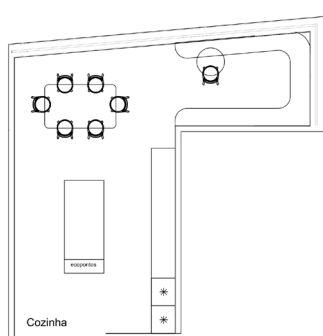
Primeiro esboço da Cozinha. Fonte: autora, em autocad.
